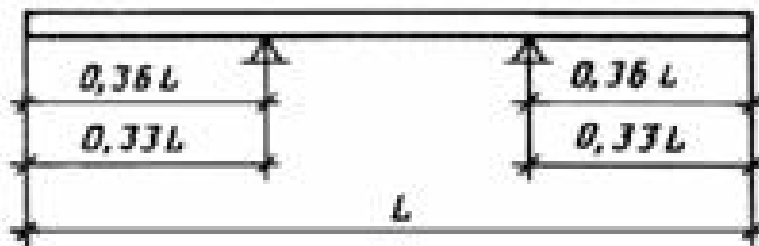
Схема испытания свай на трещиностойкость.
